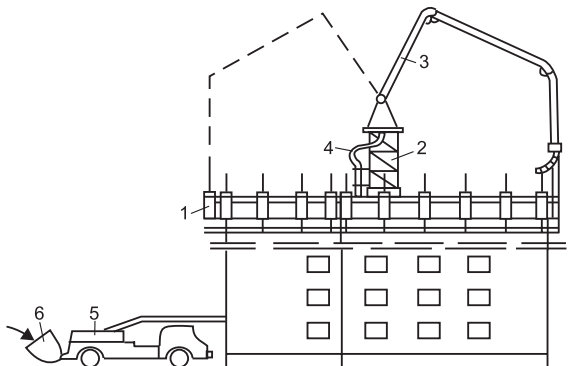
Подача бетонной смеси манипулятором при возведении монолитных зданий
